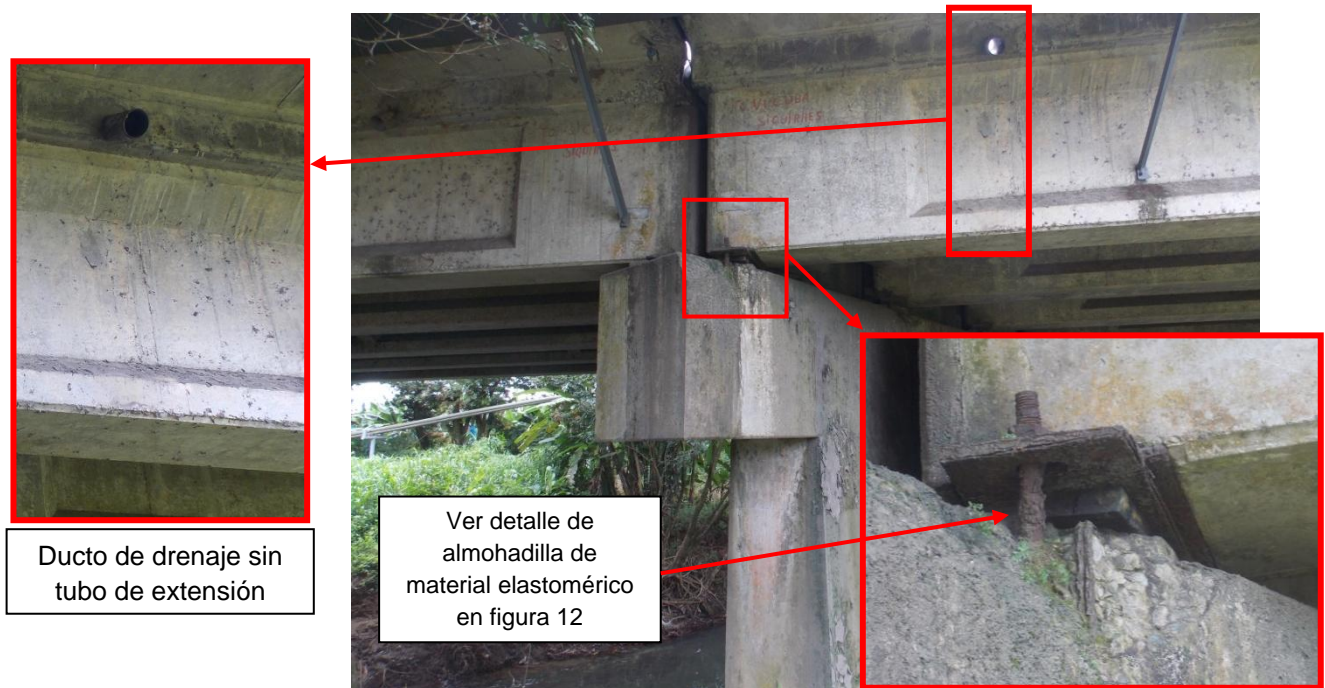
Desprendimientos de concreto en pila 1 que han reducido la longitud de asiento y ductos de drenaje sin tubos de extensión que eviten la descarga directa de agua sobre las vigas.
